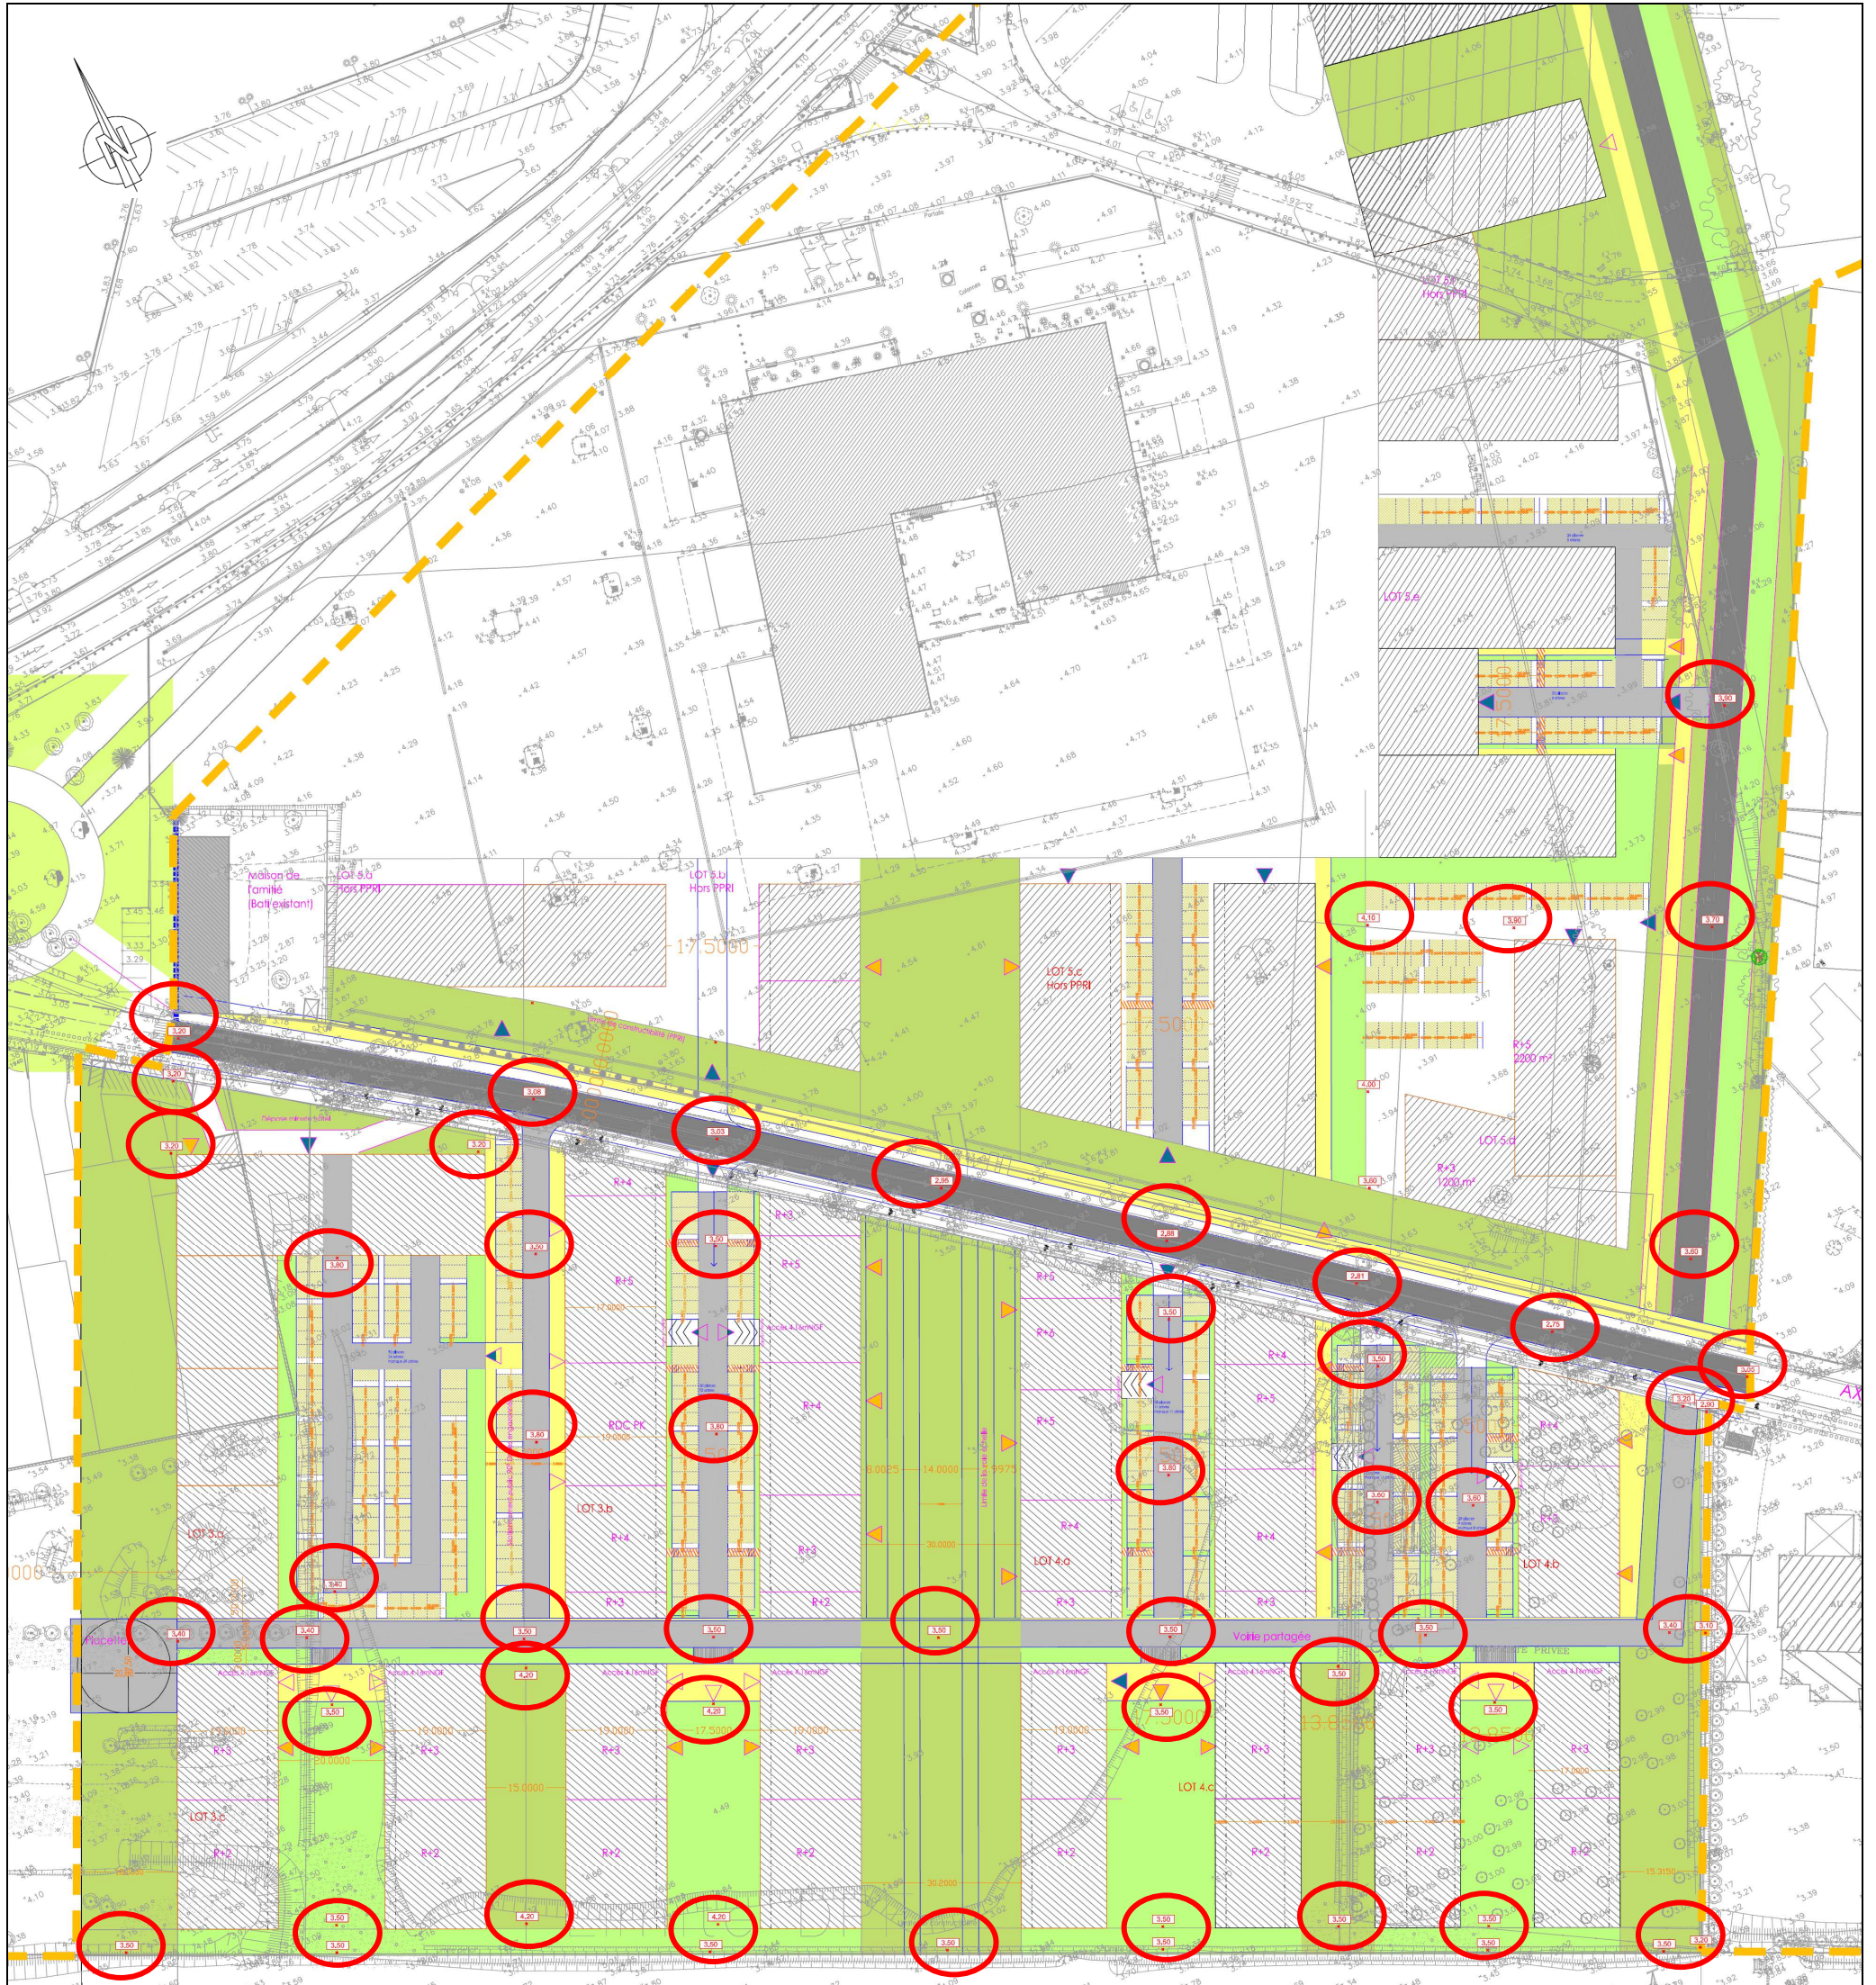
Cote plateforme du projet secteur Est Musée (sans échelle)
